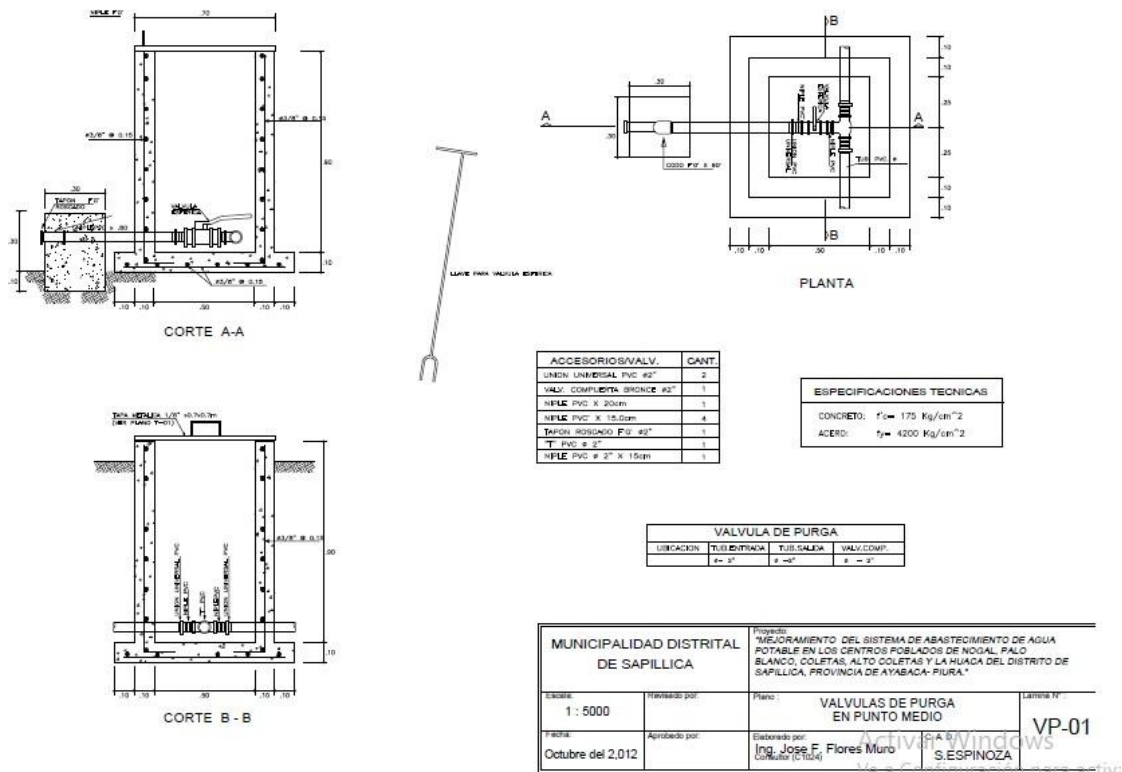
Válvula de control, planta y corte. Fuente: propia
